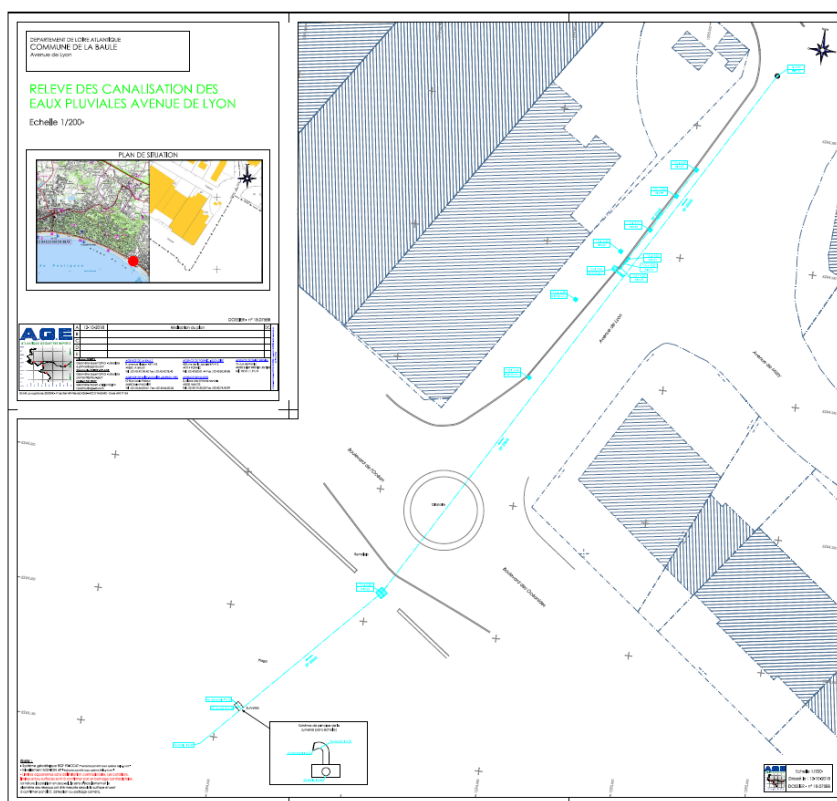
Vue en plan de la canalisation des eaux pluviales - Avenue de Lyon
